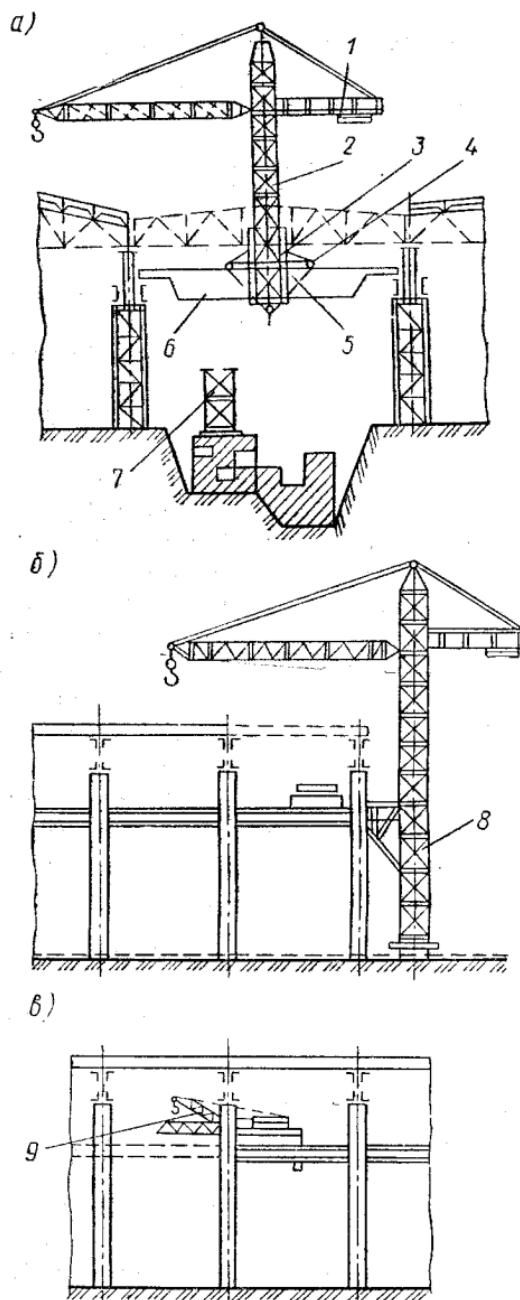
Варианты использования мостовых кранов для монтажно-демонтажных работ:
